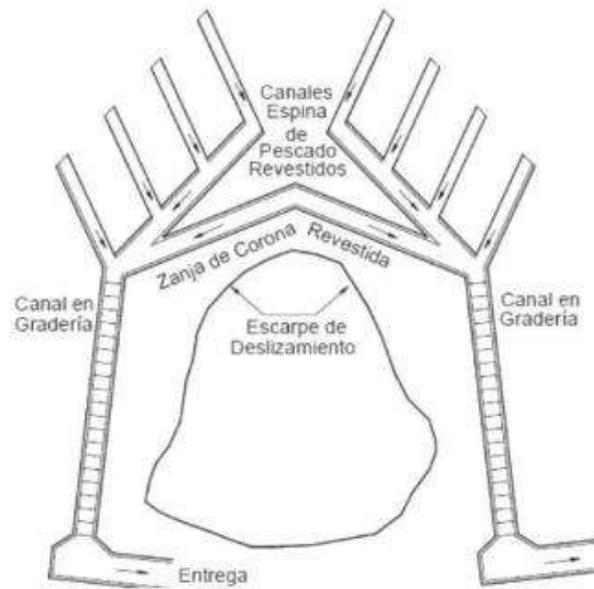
Esquema en planta de canales colectores. Espina de Pescado (Suarez, J.2010)
